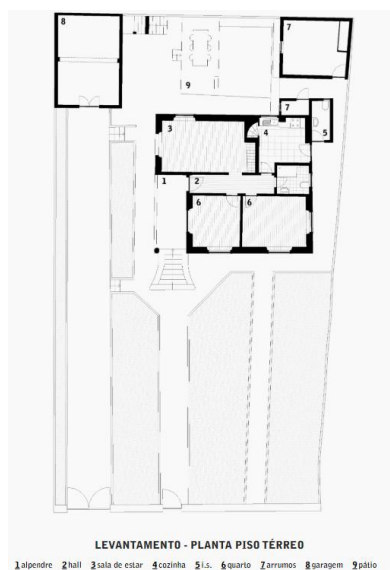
Planta do piso 0 inicial, Casa da Ericeira.
